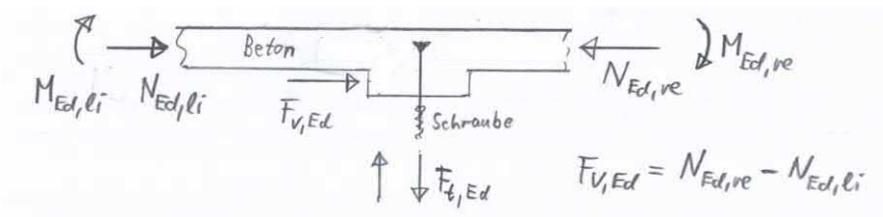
Schnittgrößen: äußere Kräfte an der Betonknagge
